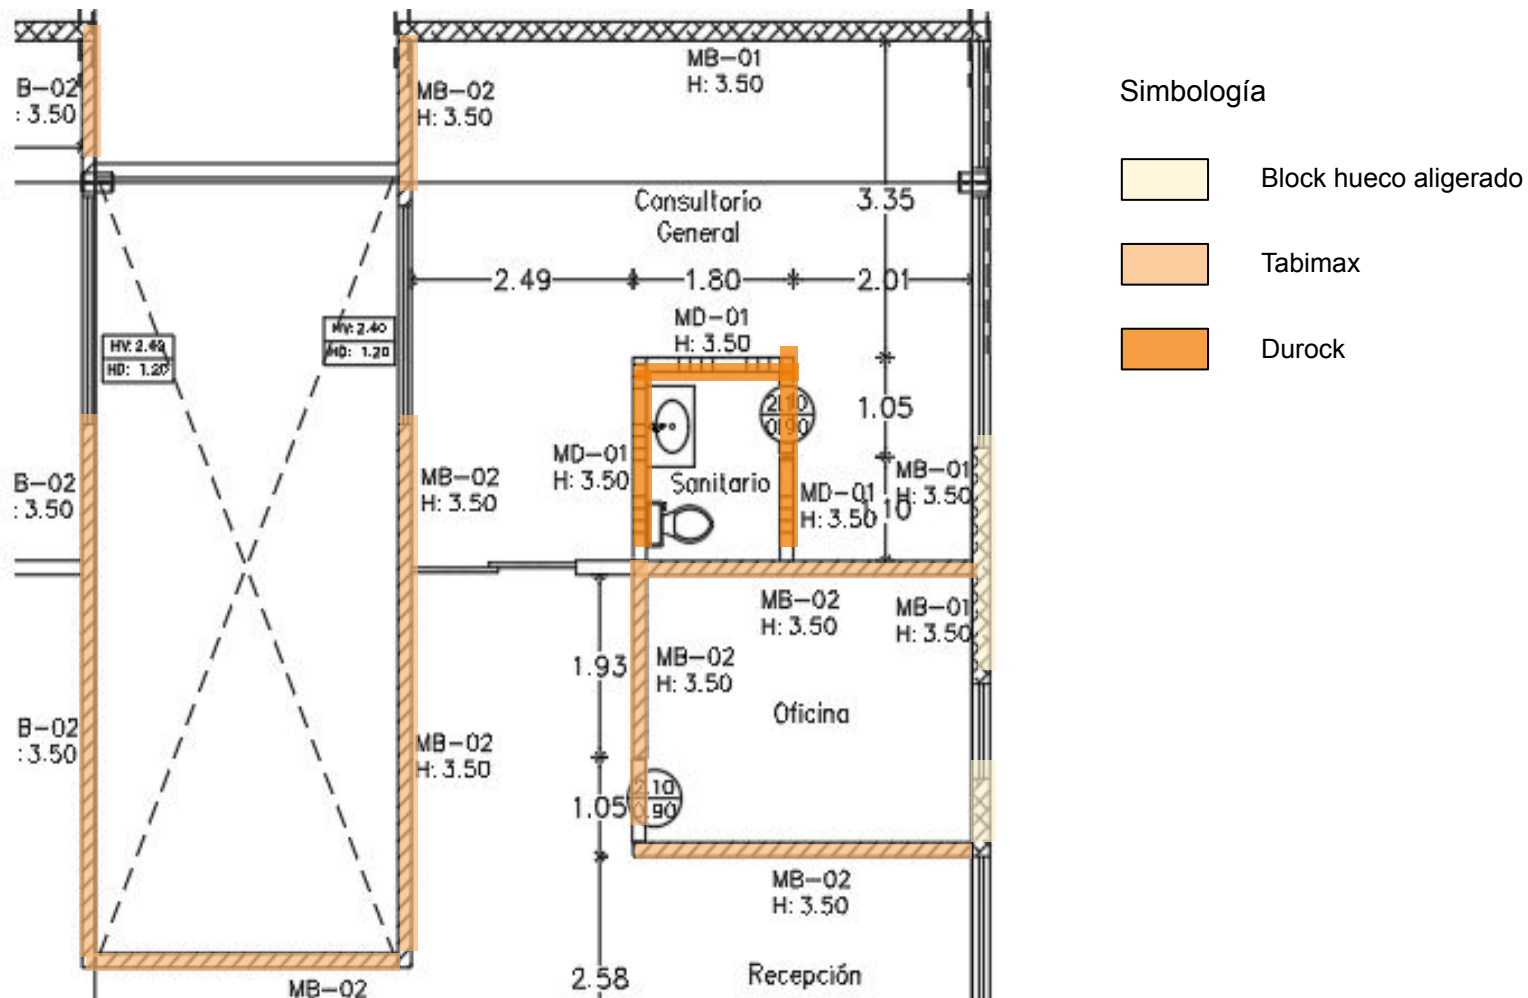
Sección de planta arquitectónica del edificio. Elaboración propia.
